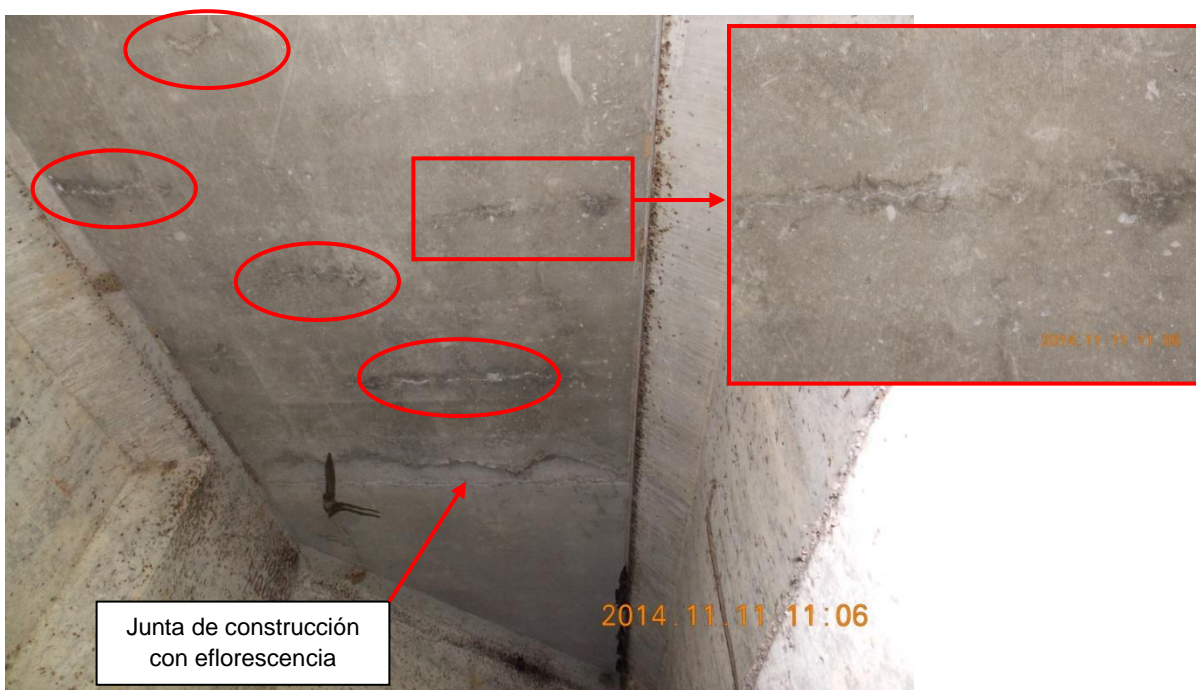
Grietas perpendiculares a la dirección del tránsito en la superficie inferior de la losa de la superestructura 1 con presencia de eflorescencia.
